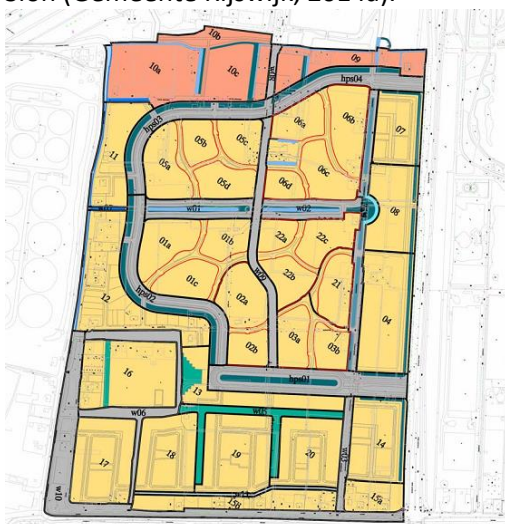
Overzicht deelplan Sion (gemeente Rijswijk, 2014a)
